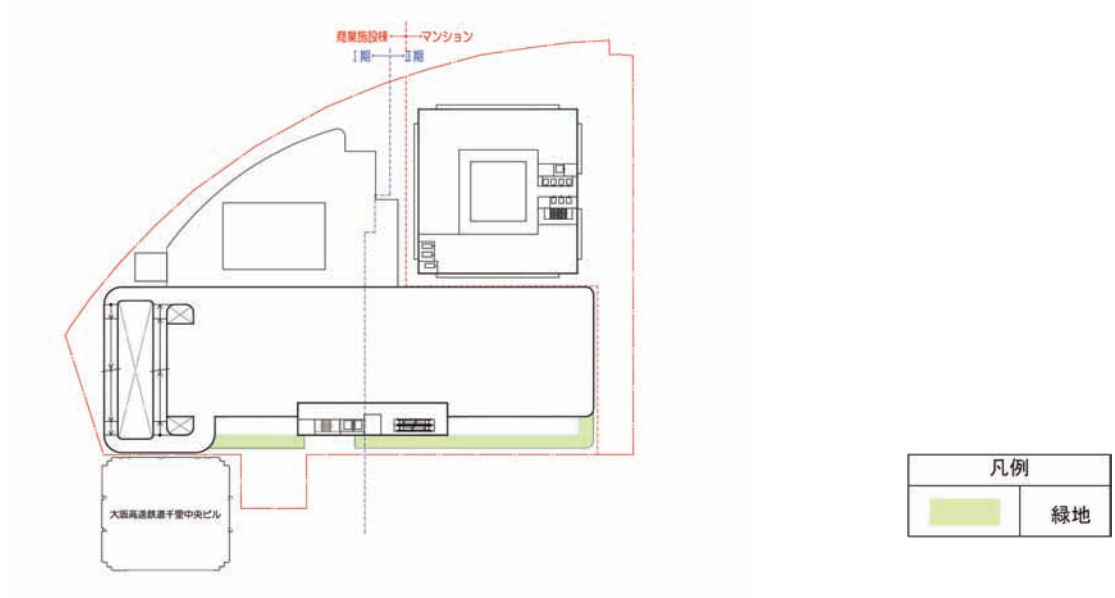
(2) 緑化計画の平面図 (低層部屋上)
